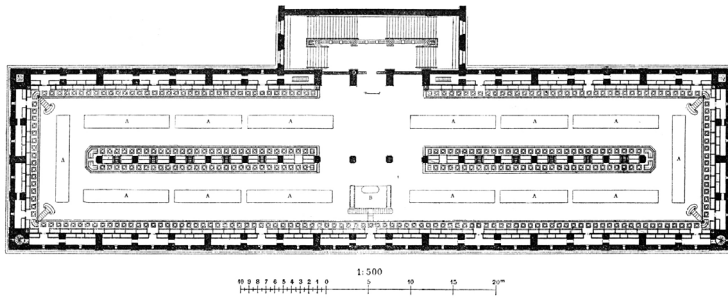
Planta da Biblioteca de Sainte Geneviève
